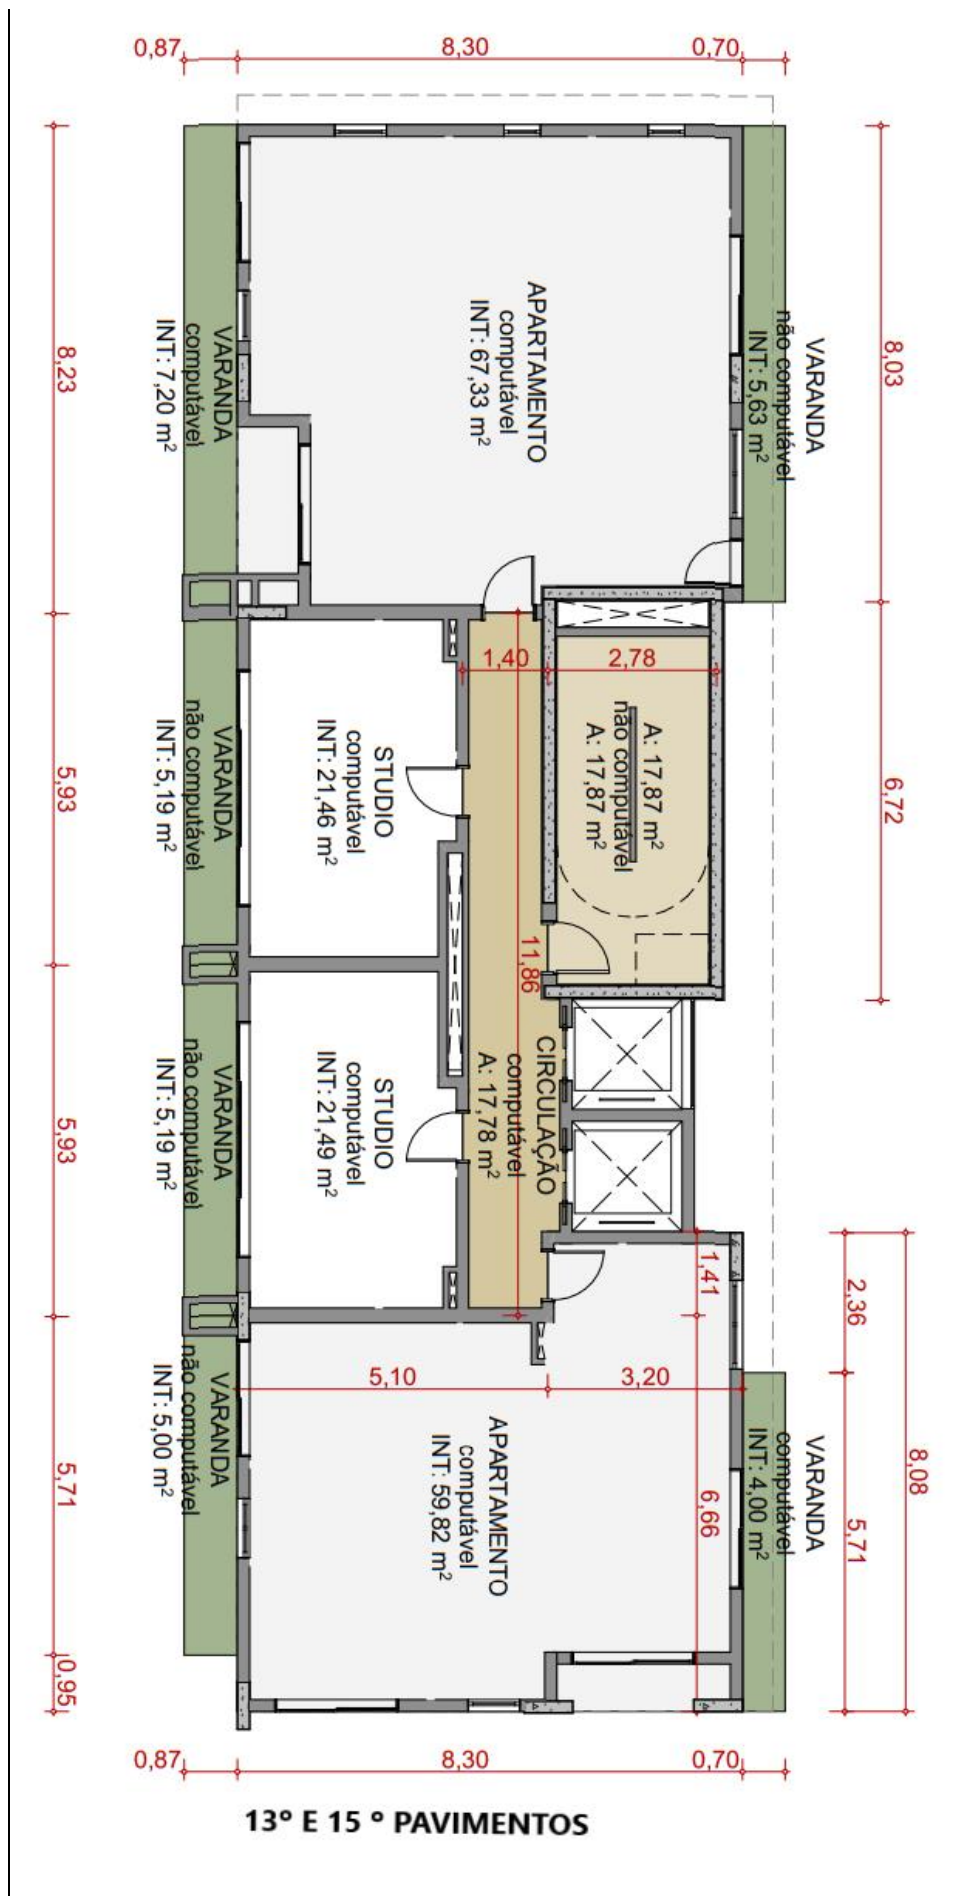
Planta Tipo do 13º e 15º Pavimentos do Condomínio Sintropia Sky Garden.
